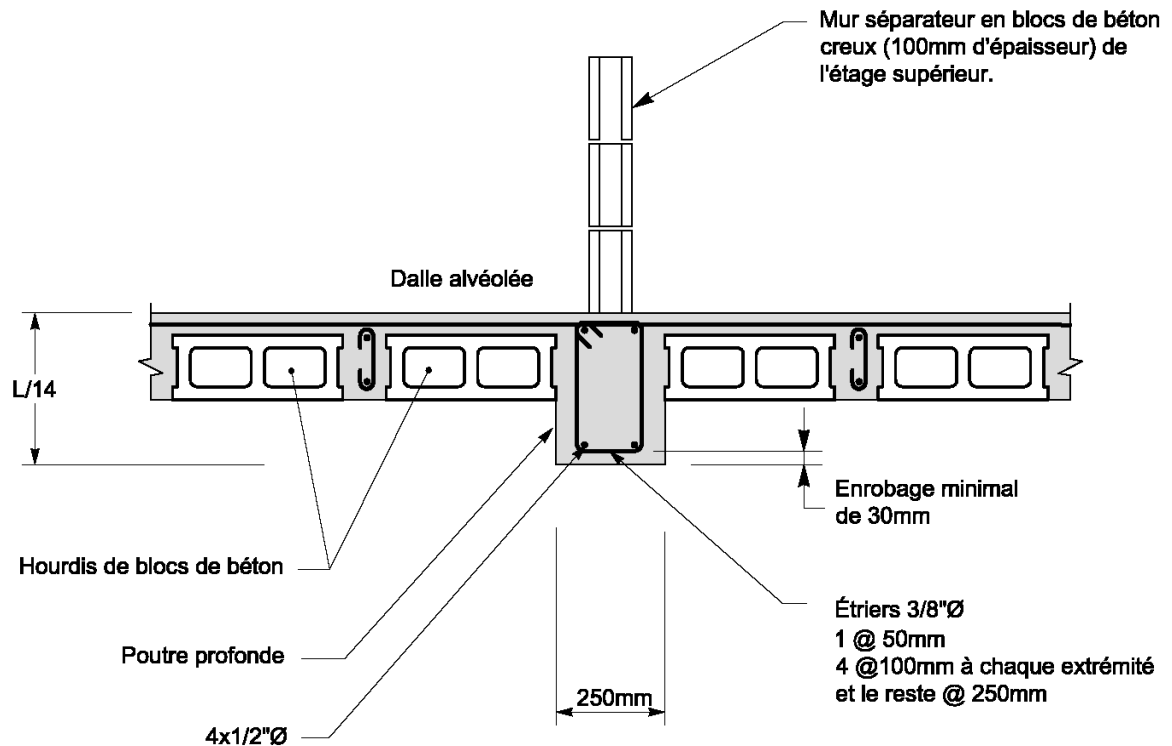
Poutre profonde dans une dalle alvéolée
